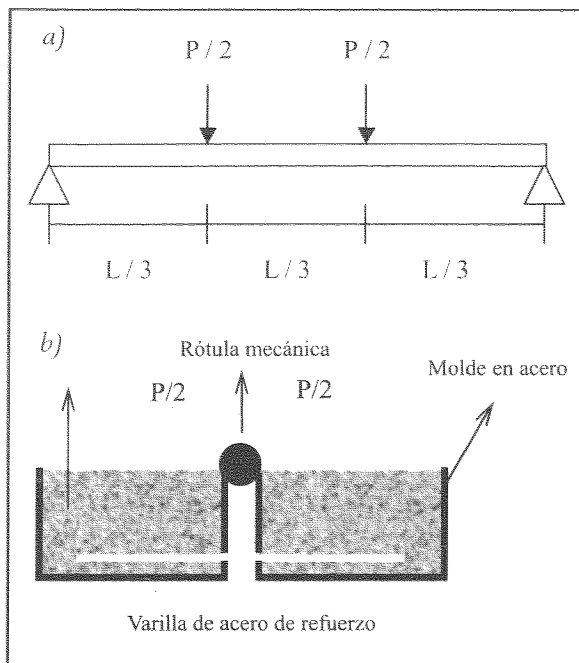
a) Viga simplemente apoyada con cargas en los tercios de su longitud. b) Dispositivo de ensayo y equilibrio de fuerzas internas en la zona central de la viga
